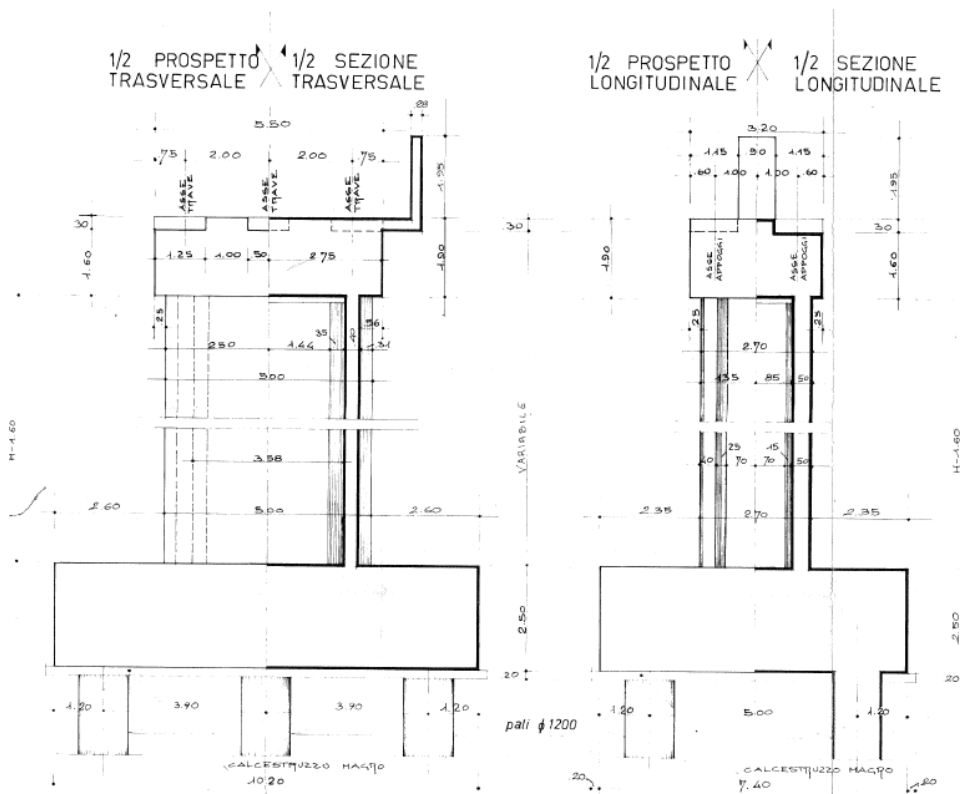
Prospetto Longitudinale e Trasversale Pila
